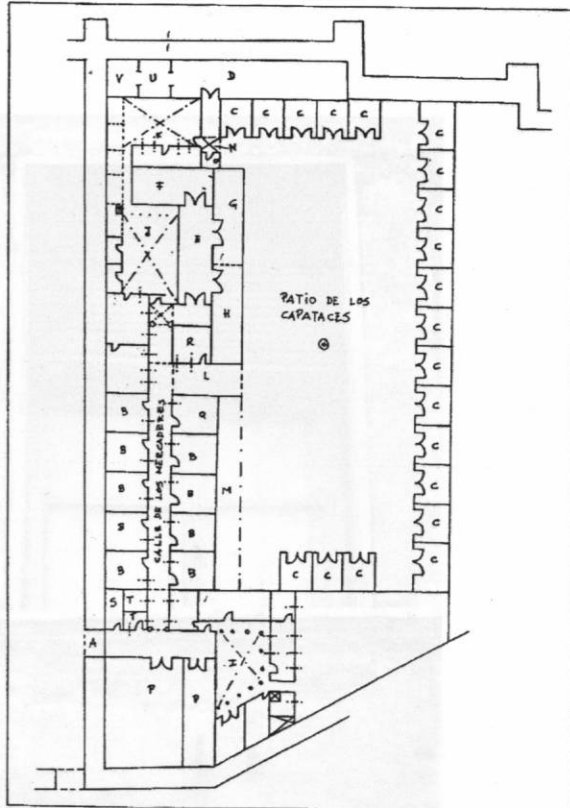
Plano reconstrucción hipotética de la Casa de la Moneda. Siglo XVI.
